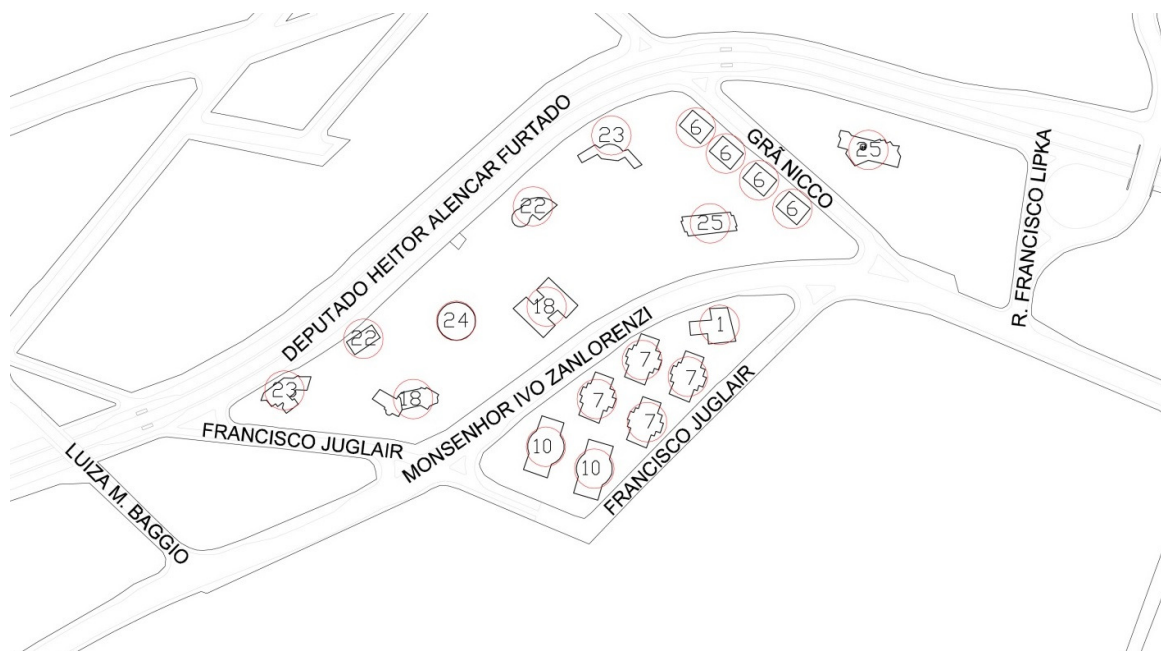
ÁREA III – PLANTA COM NÚMERO DE PAVIMENTOS DOS EDIFÍCIOS
